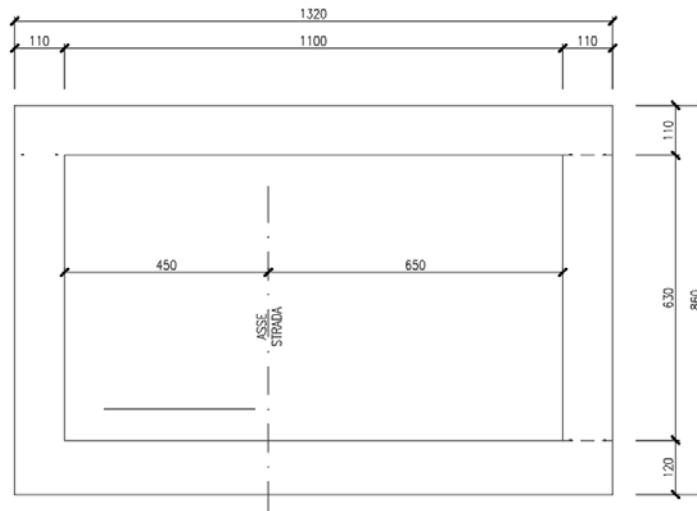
Sezione trasversale tipica dello scatolare con dimensioni "di calcolo"
